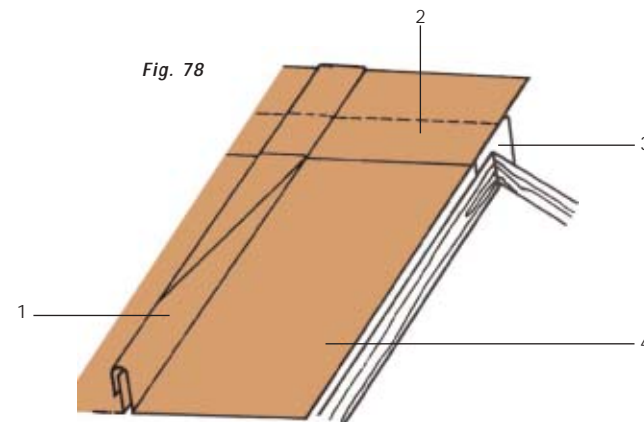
Detalhes construtivos - união das juntas elevadas com a cumeeira executada com caibro.
